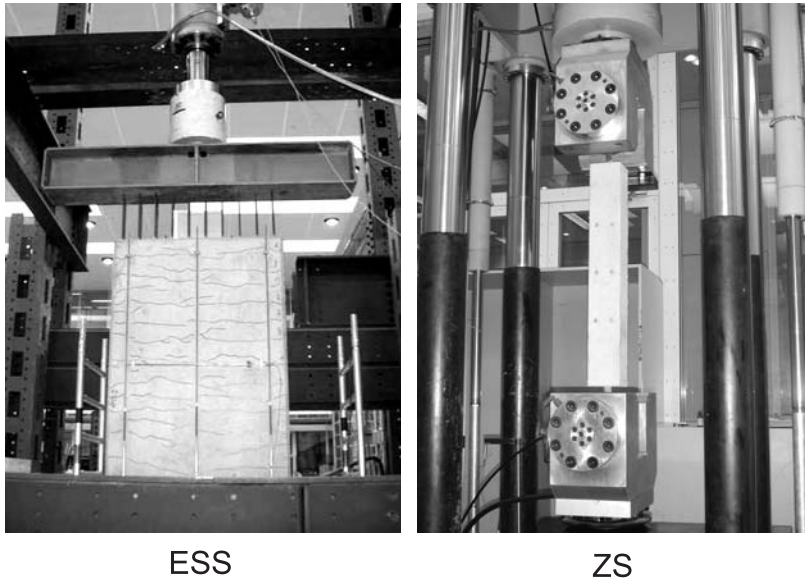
Versuchsaufbau für Stahlbetonscheiben (ESS) und -stäbe (ZS)
